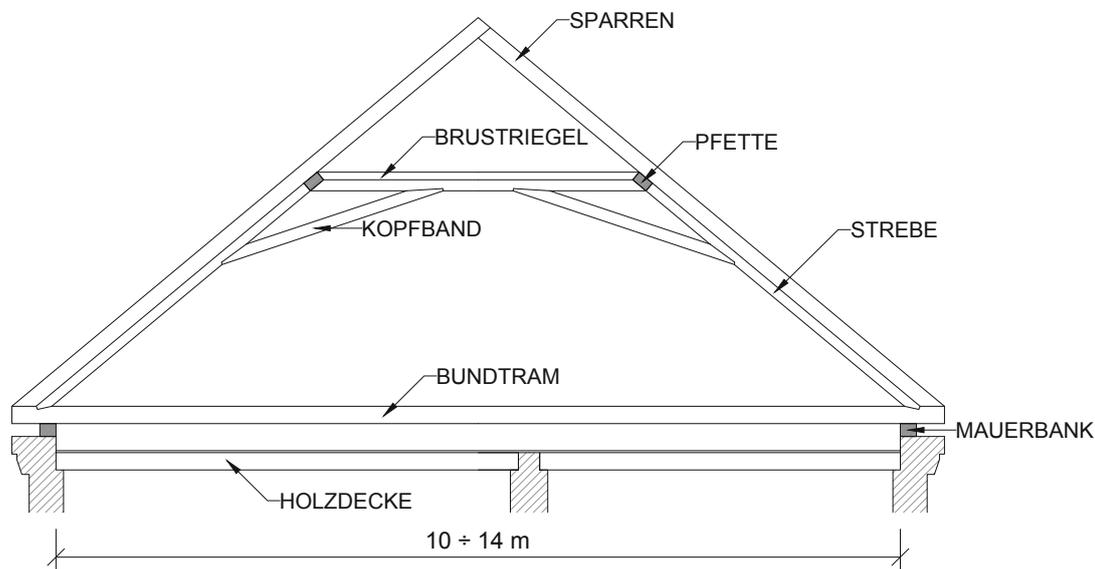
Dachtragwerk mit liegendem Stuhl nach [74]
